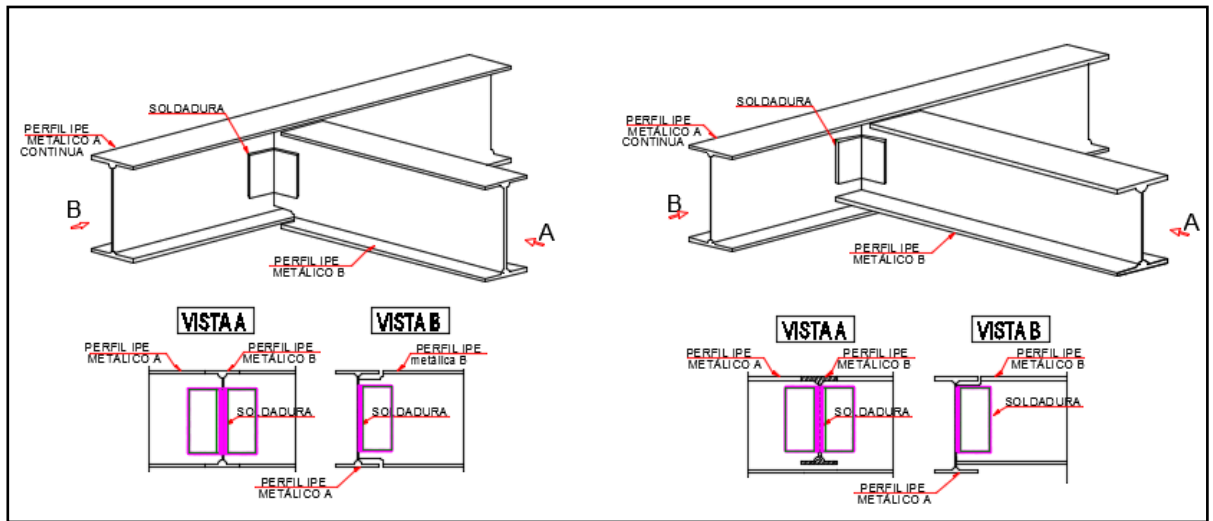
Conexión metálica viga a viga [Carreño J., Cañarte J., 2019]
